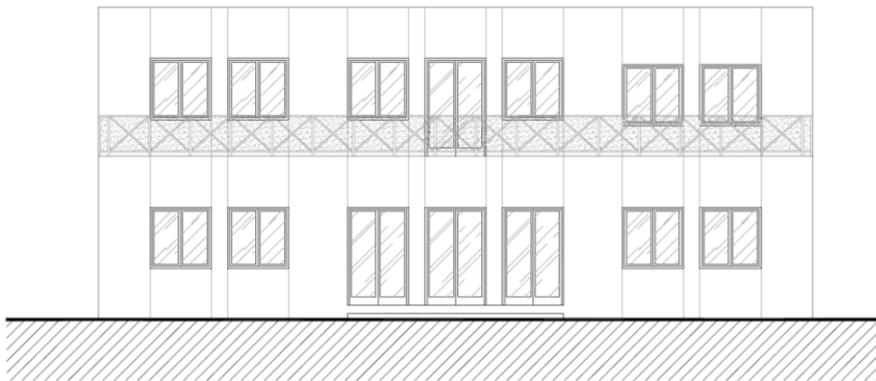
“Piccola palazzina per uffici. Prospetto Sud”
